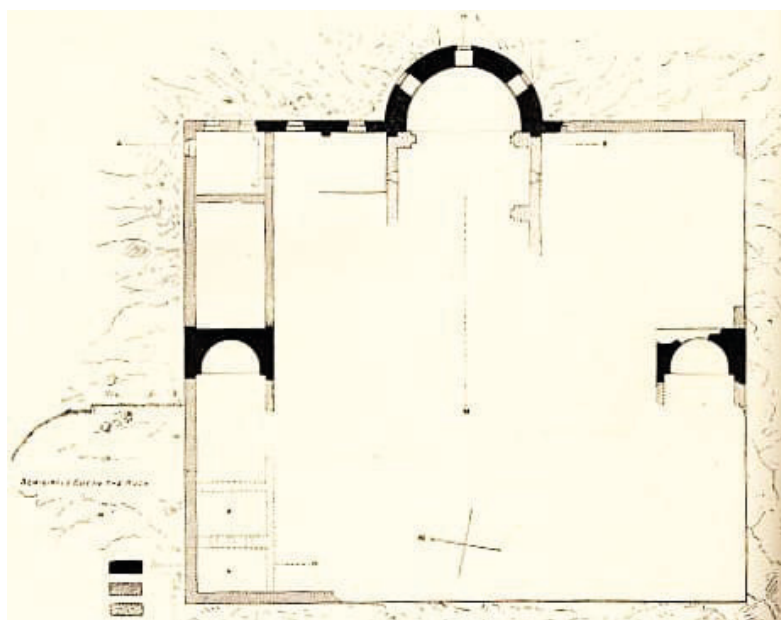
Pianta dell'intera struttura basilicale rilevata. Identificate con campitura nera le strutture ancora in piedi all'epoca. (Clermont-Ganneau 1896, p. 448).
